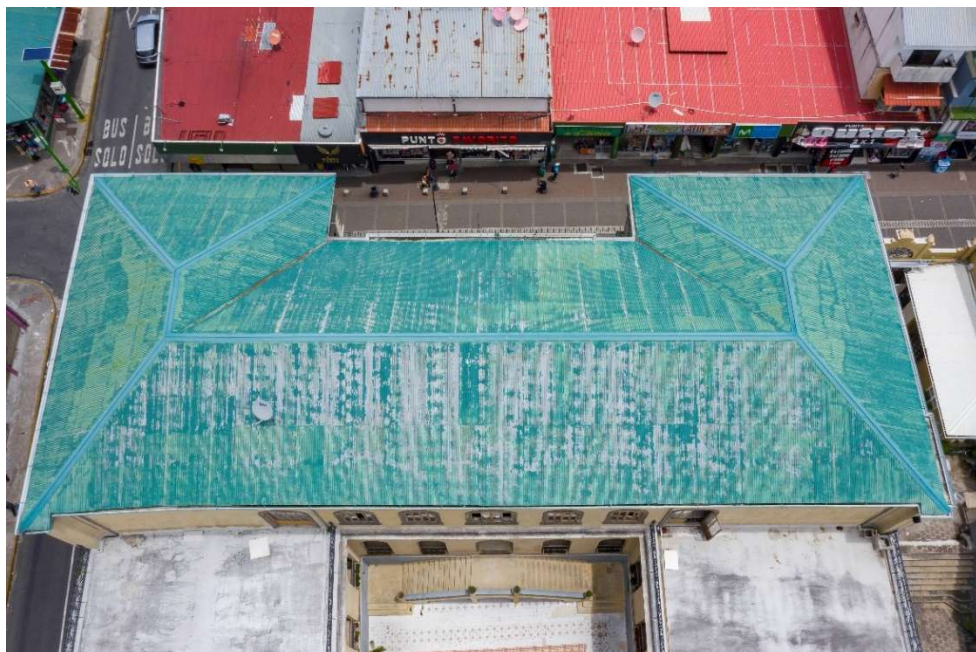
Estado actual de la cubierta sobre el segundo nivel.
